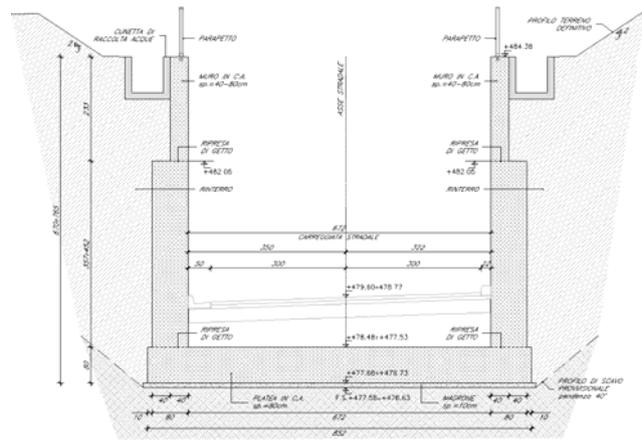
Sezione trasversale del muro di rampa RE-01 e RO-01
